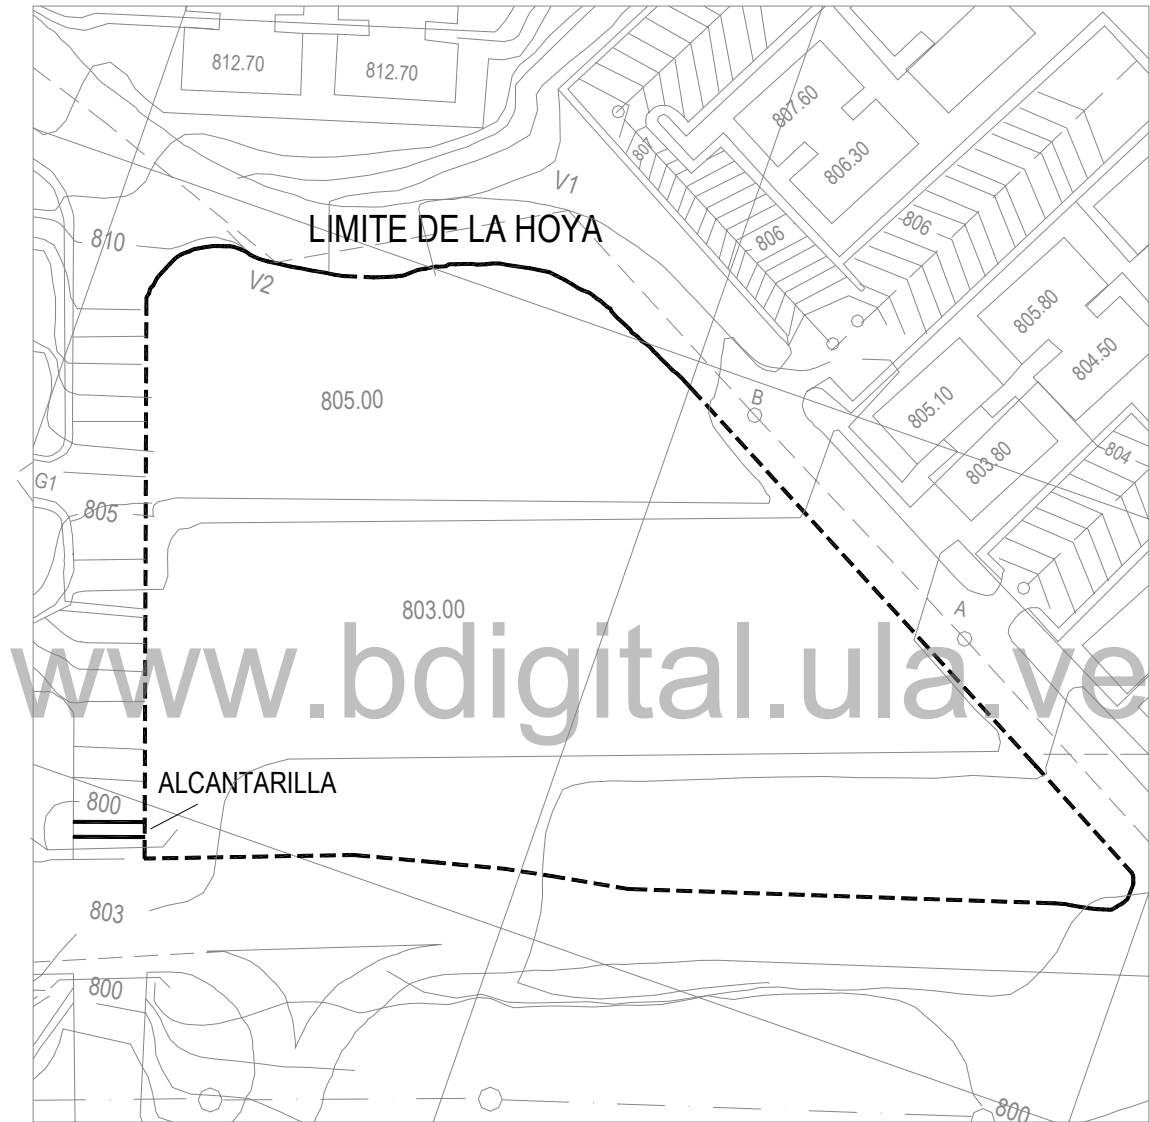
Sistema con pozo de detención con salida por alcantarilla
